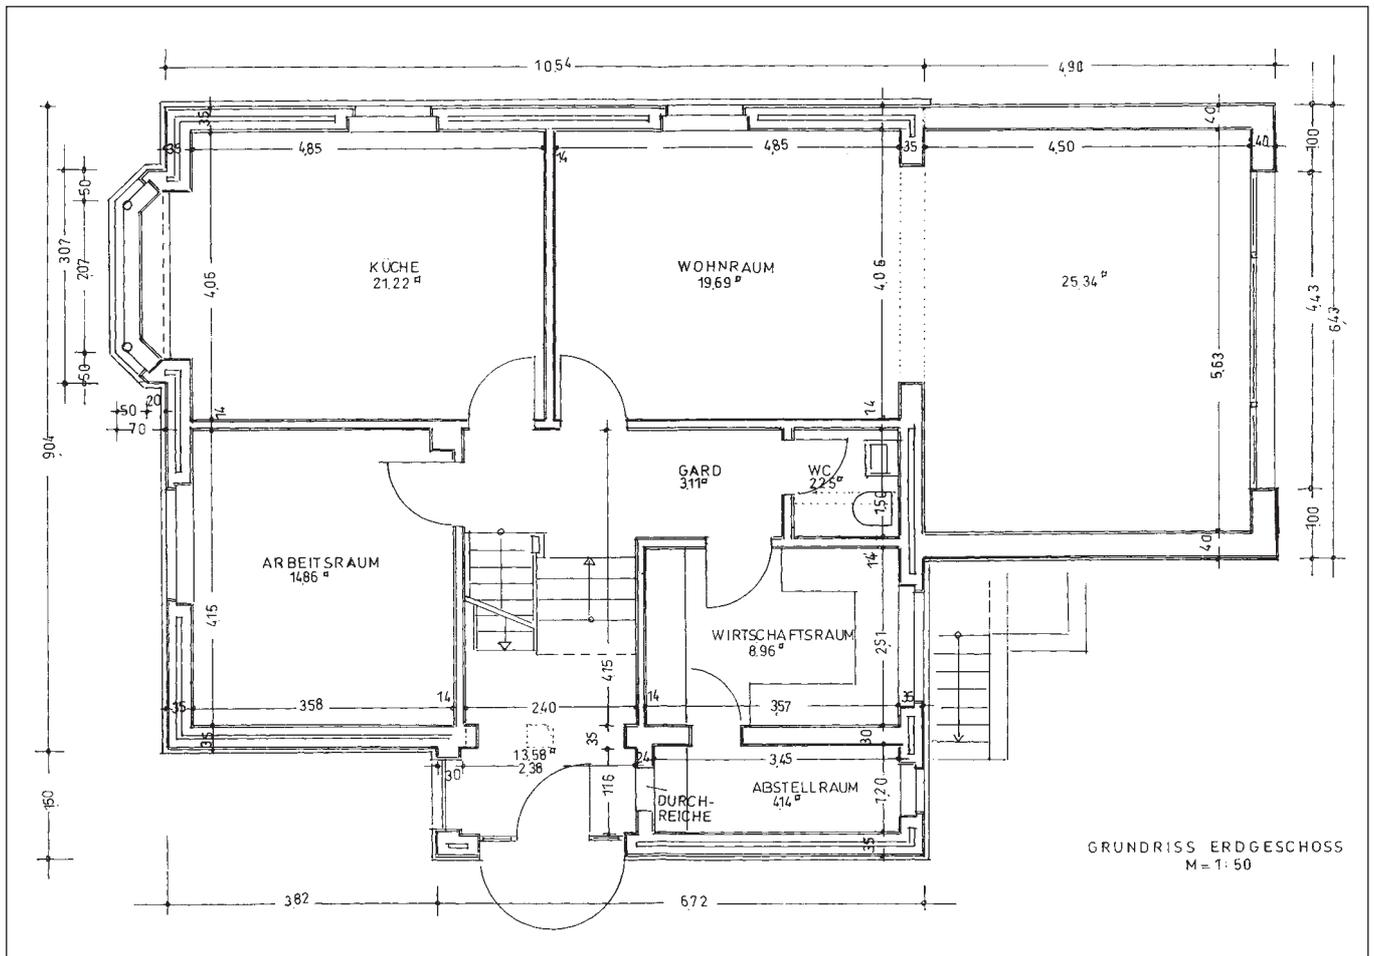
Beispielwohnung, Grundriss EG
